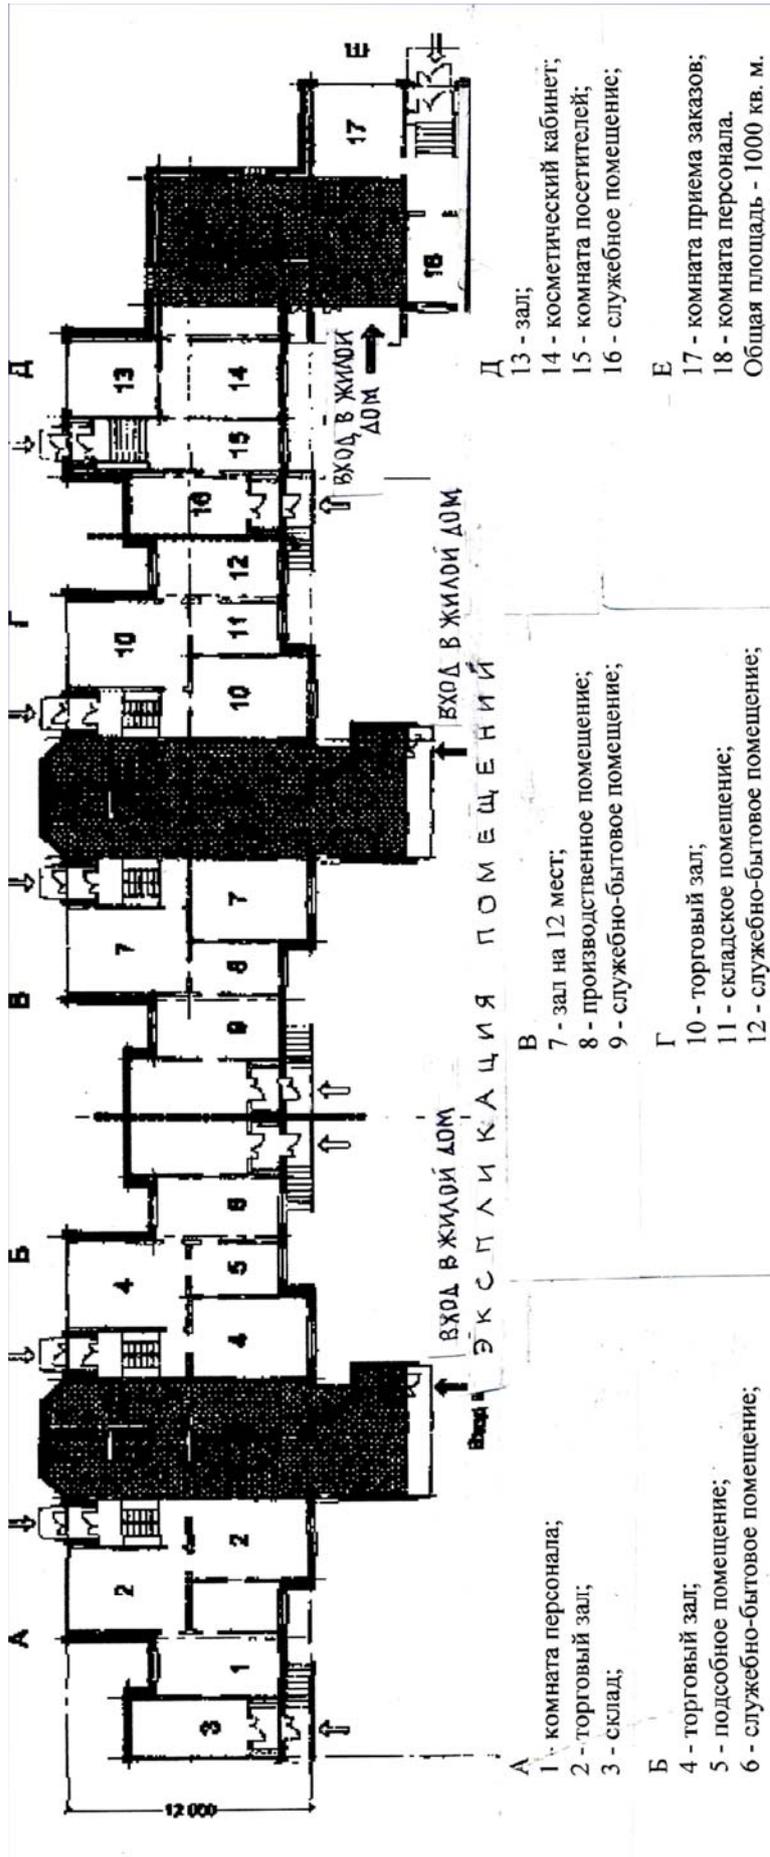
Пример планировочного решения комплекса предприятий малого бизнеса на первом этаже жилого дома [6]
